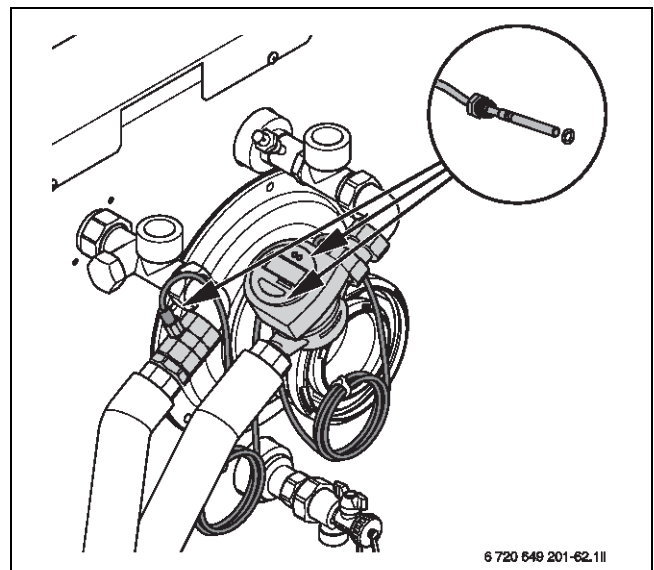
Einbauposition Anschluss-Set Wärmemengenzähler
